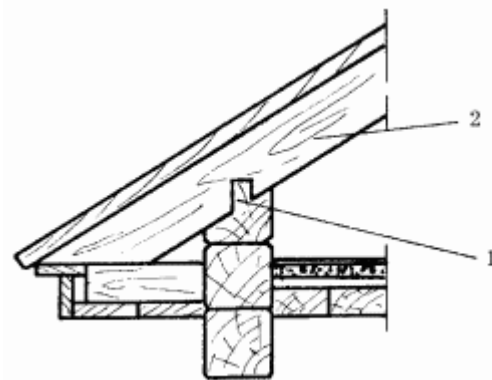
Опираие наслонных стропил в деревянных, рубленых или брусчатых домах: 1 – шип; 2 – стропильная нога.
